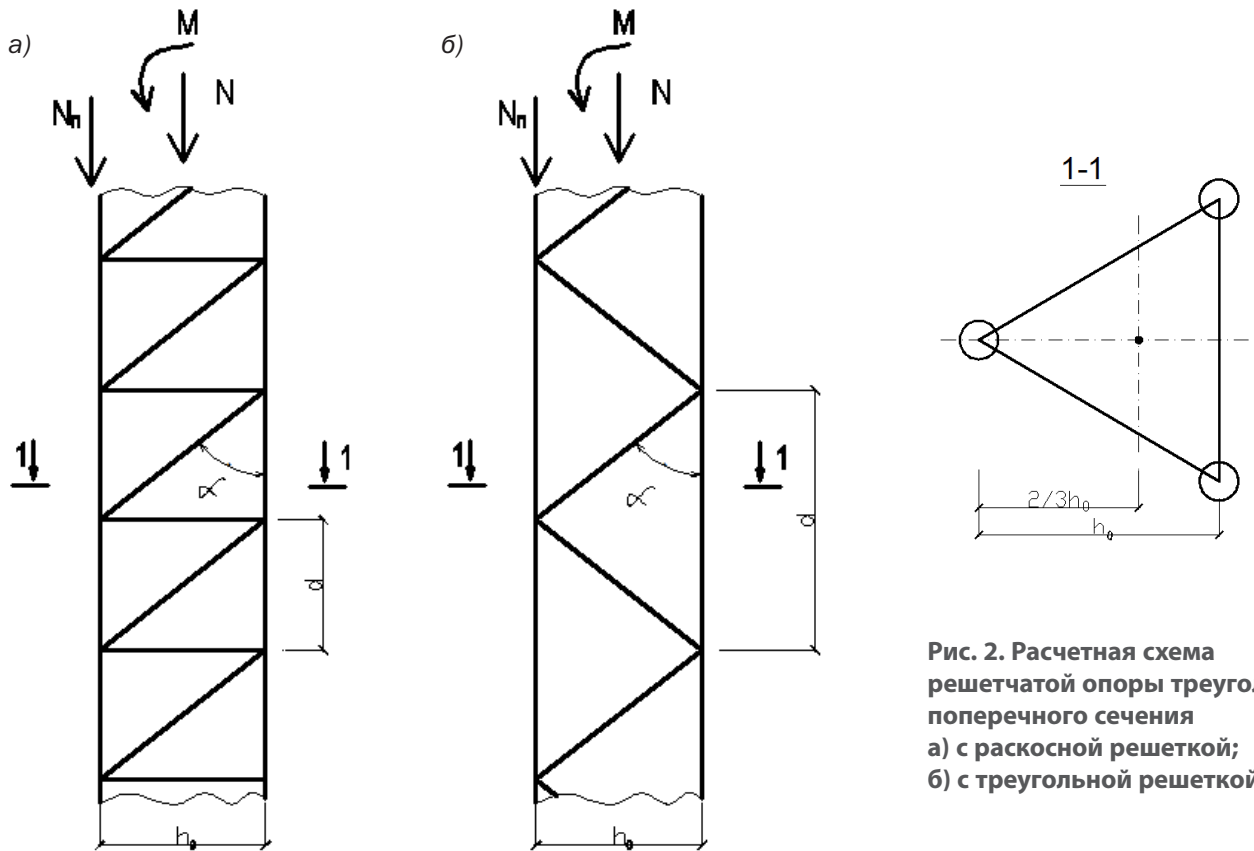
Расчетная схема решетчатой опоры треугольного поперечного сечения
